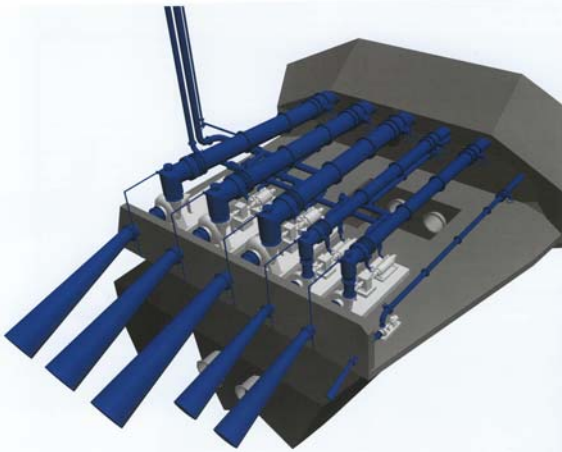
Modular aufgebaute Wasserförderanlage (Planungszustand; untere Abbildung ohne Grundablassrohre)
